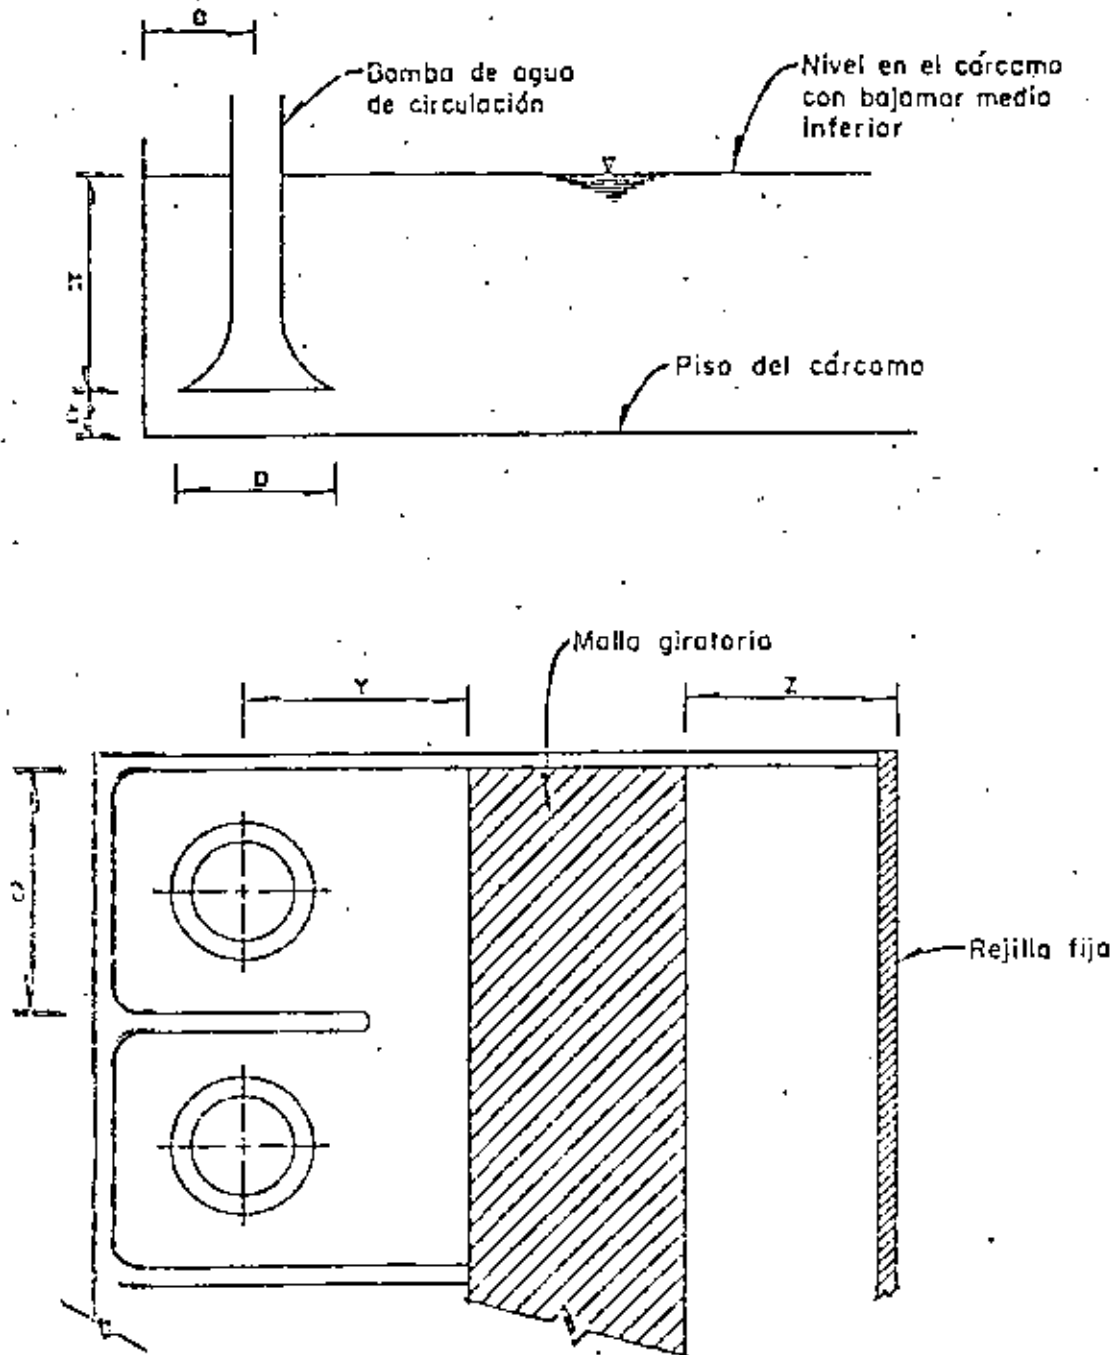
Dimensionamiento del cárcamo de bombeo
